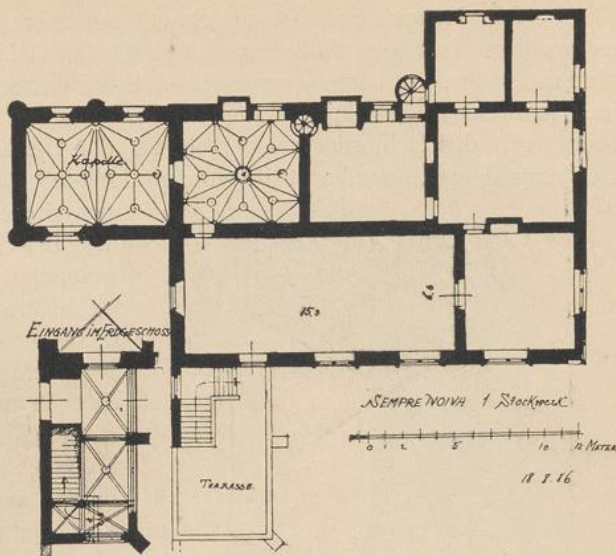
Grundriss des Schlosses Sempre noiva bei Evora. Oberes Stockwerk.
